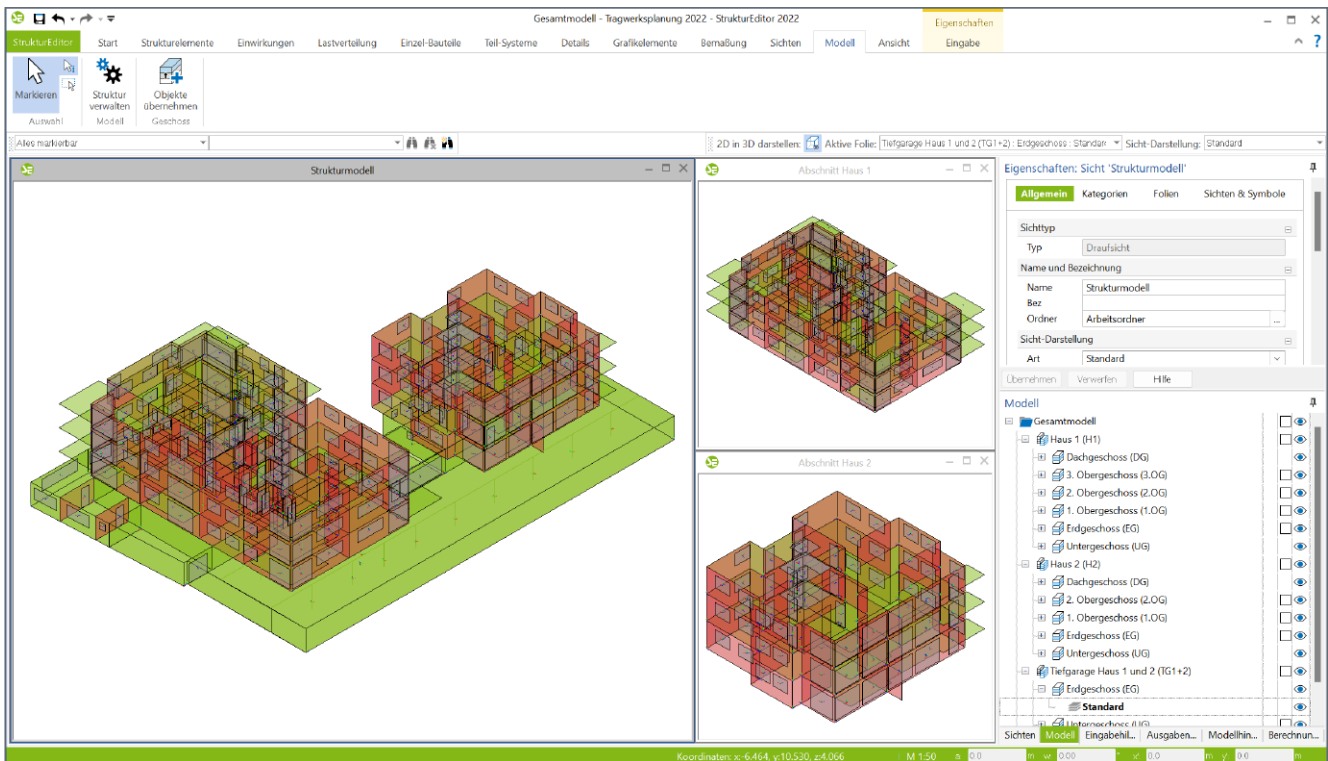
Komplexes Strukturmodell mit drei Abschnitten (Haus 1, Haus 2 und Tiefgarage)
